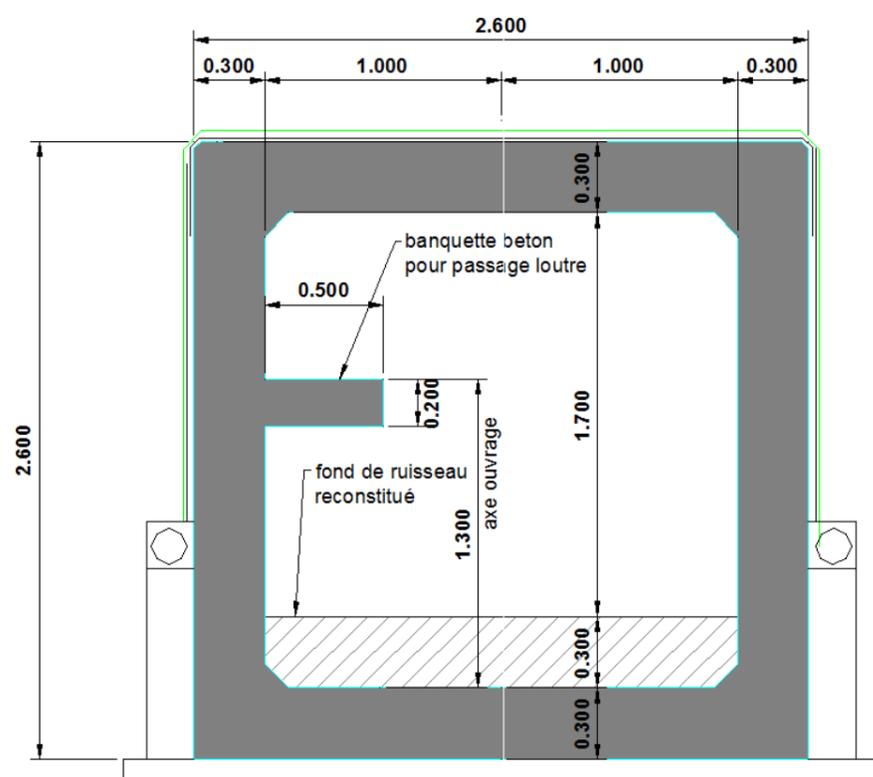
Coupe transversale de l'OH (source ARCADIS)
